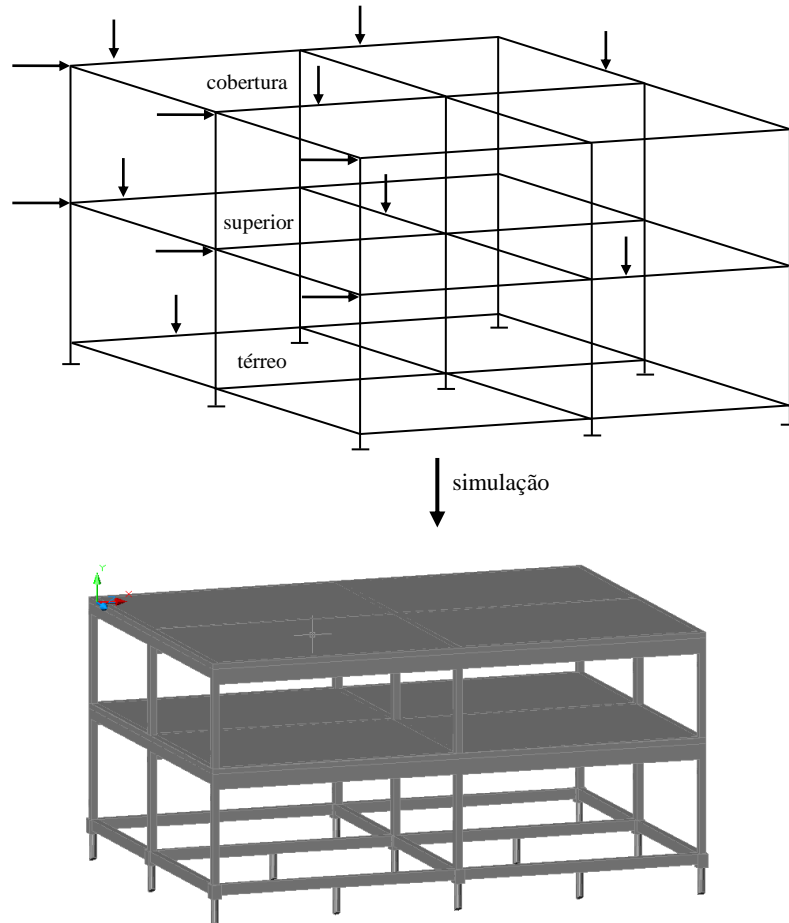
Vigas e pilares da estrutura segundo a analogia de pórtico espacial.
